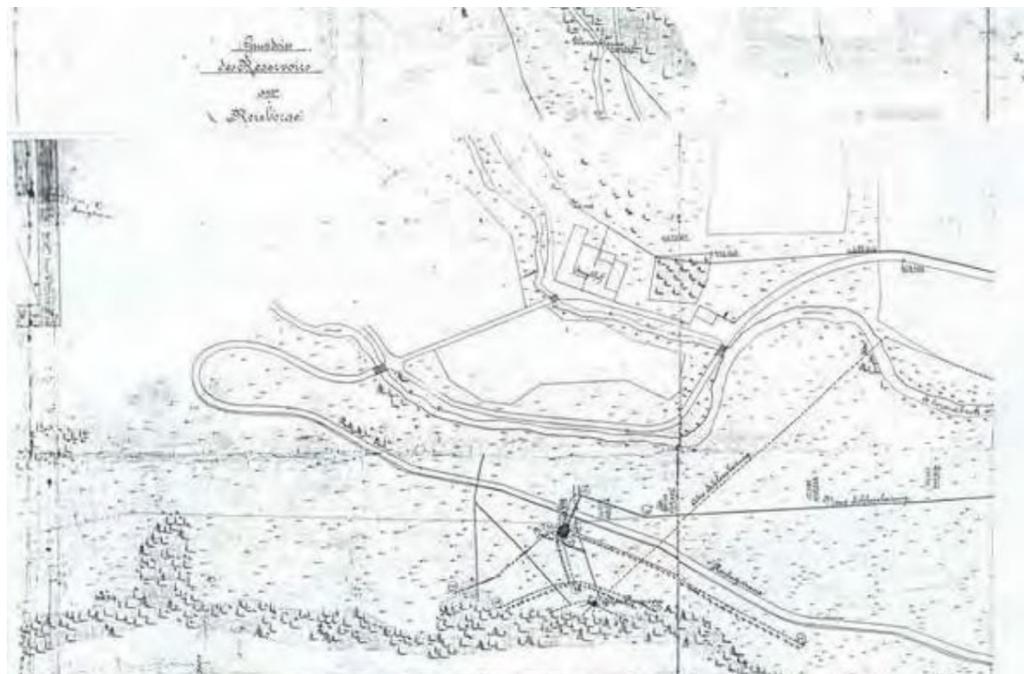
Situationsplan der Wasserleitung unter Jakob Rappaport, 1880.
